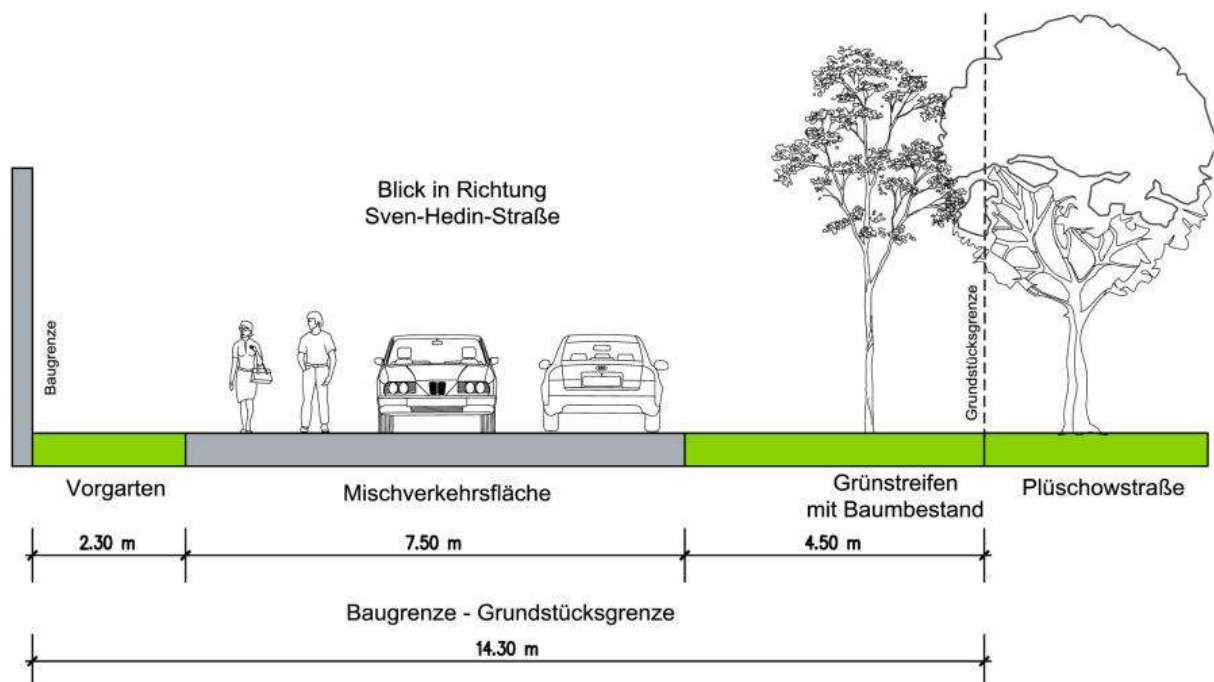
Privatstraße Fläche „b“, Blick in Richtung Sven-Hedin-Straße
